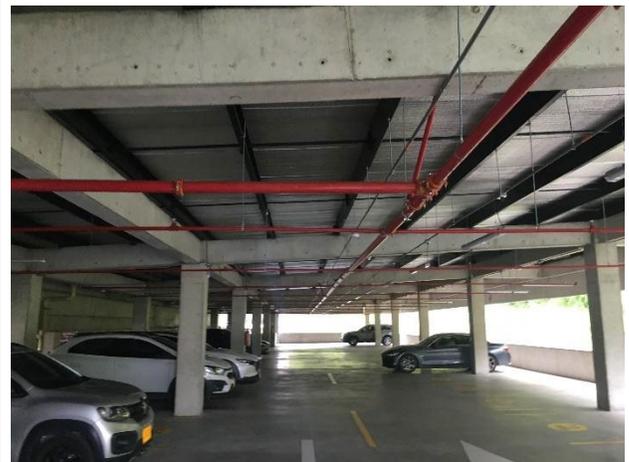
Áreas de parqueaderos en Piso 2. Techo correspondiente a una cubierta liviana metálica. Torre Zairina.
